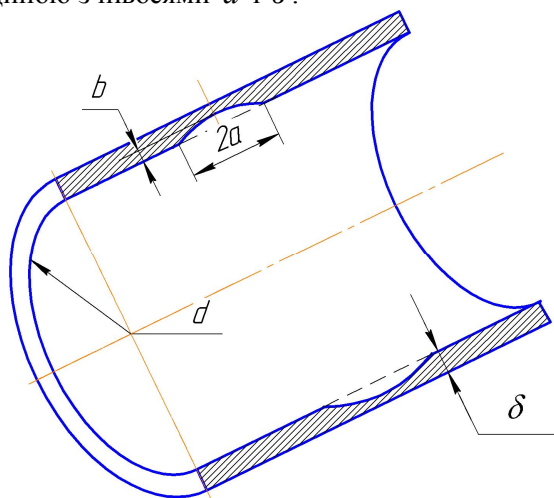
Типове розташування тріщини на внутрішній поверхні труби
